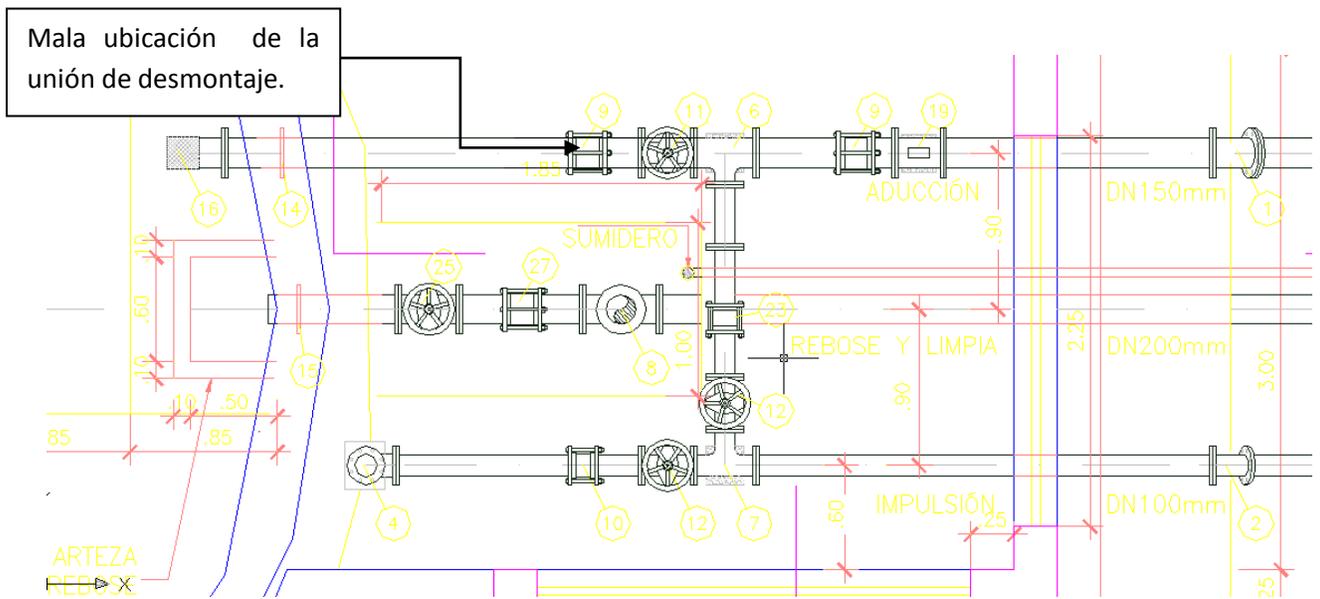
Vista de planta en el plano de proyecto reservorio RP-3 Amauta Ate
